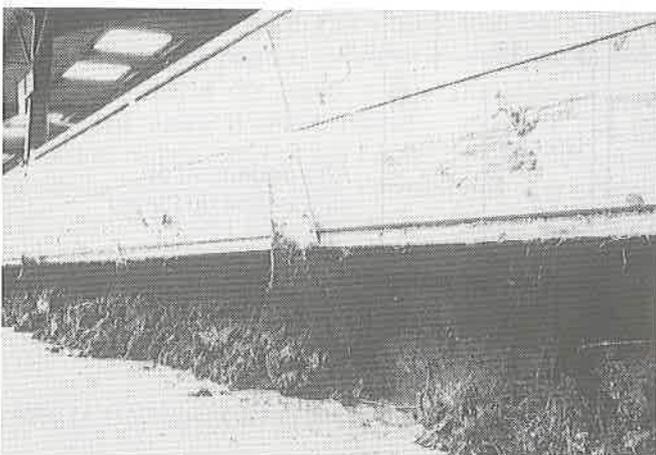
Vue du fumier qui sort par-dessous la crèche.
